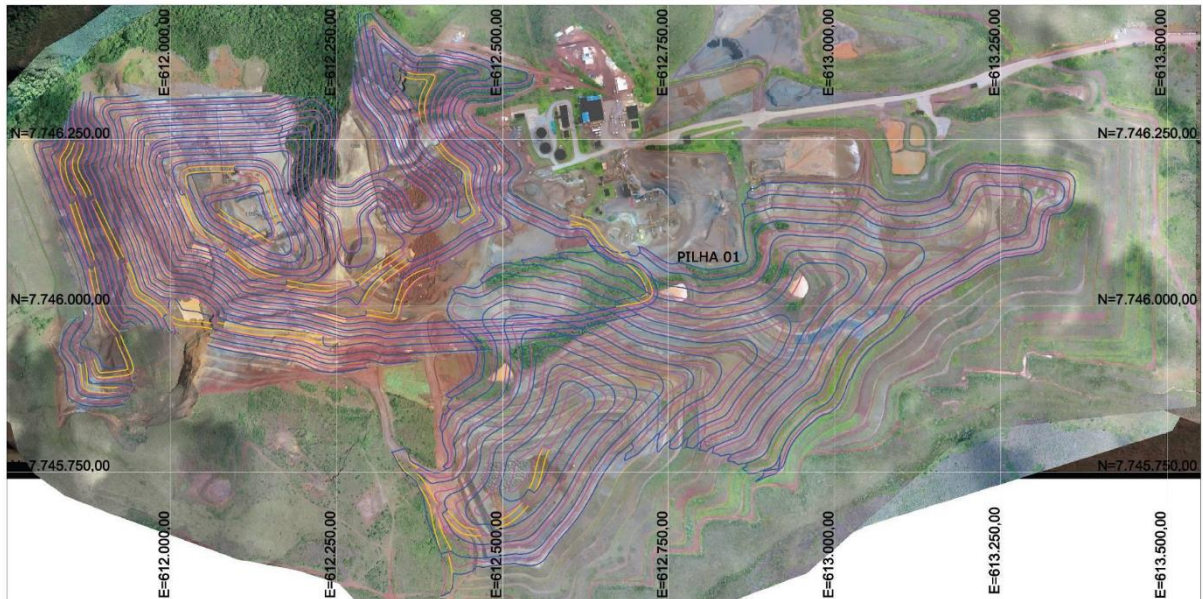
Planta da configuração final da Pilha Principal, sobre imagem de satélite.
